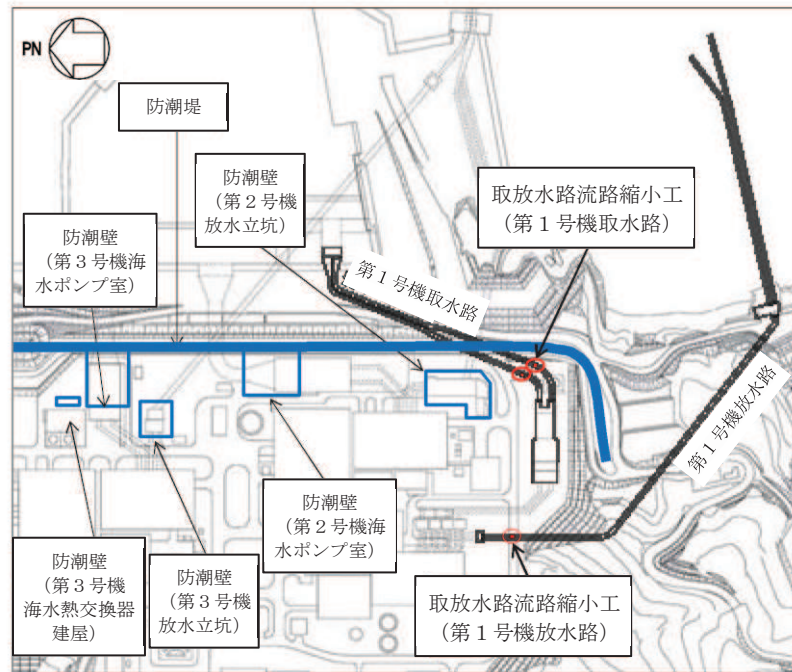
取放水路流路縮小工（第1号機放水路）の位置図（全体平面図）
